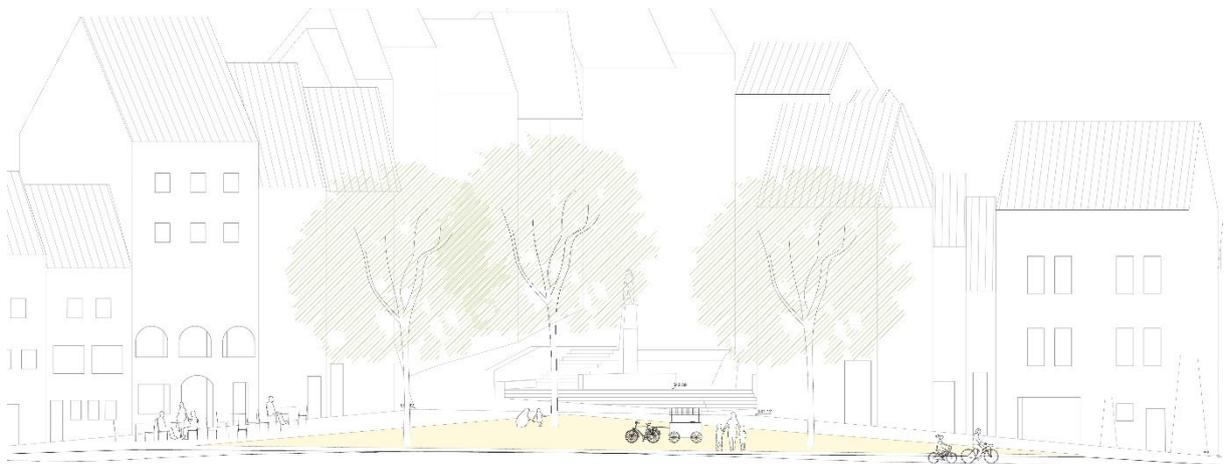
Coupe sur la place du Petit-Saint-Jean
